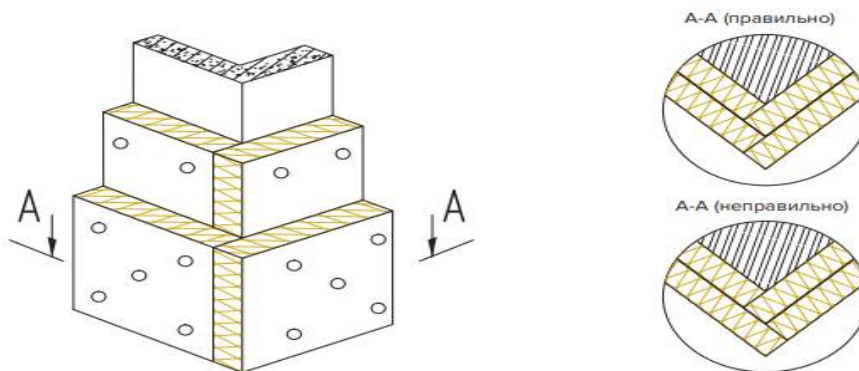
Схема укладання та кріплення плит утеплювача у два шари на кут будівлі.
